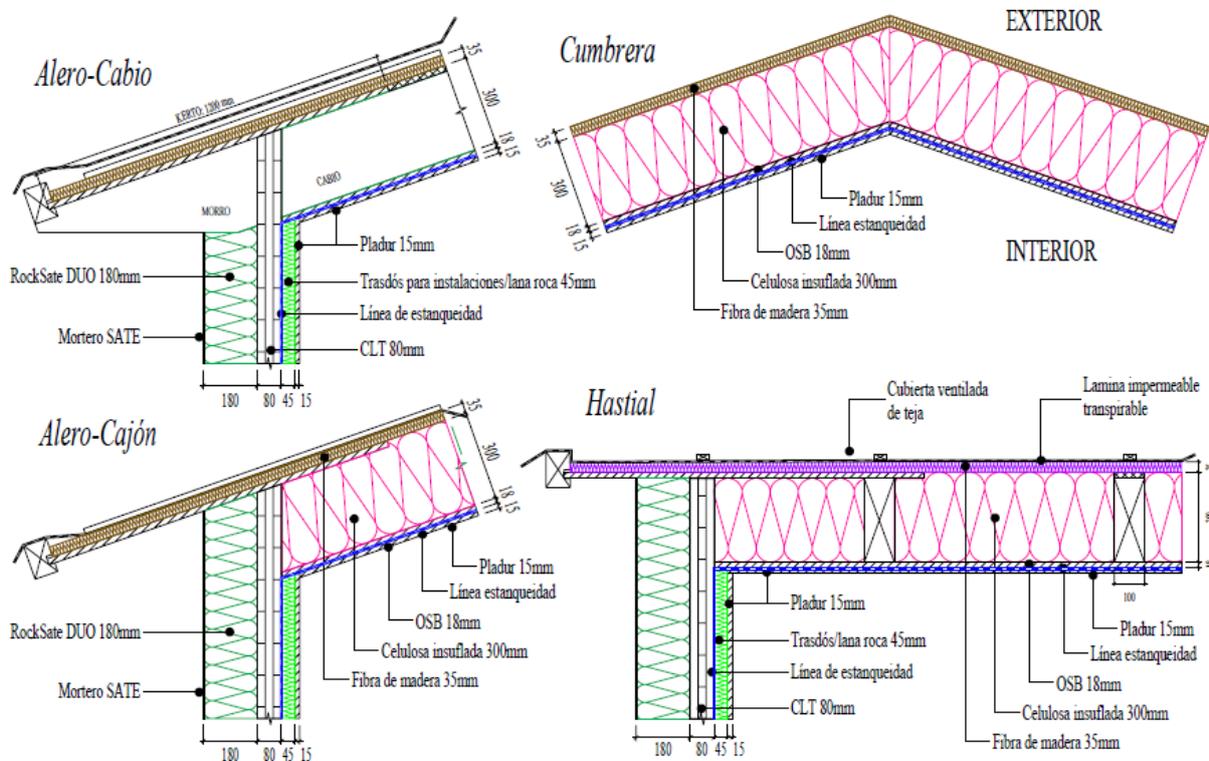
Sistema constructivo de la cubierta: detalle de aleros y hastiales.
